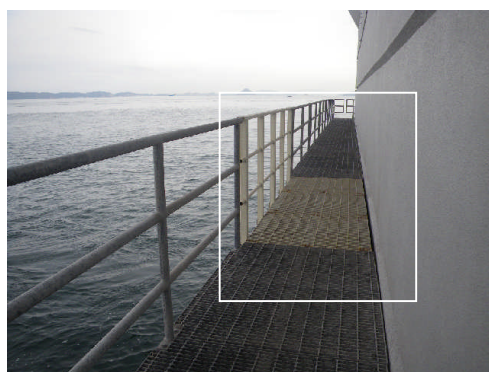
南備讃瀬戸大橋4A外周管理路上の試験施工体
